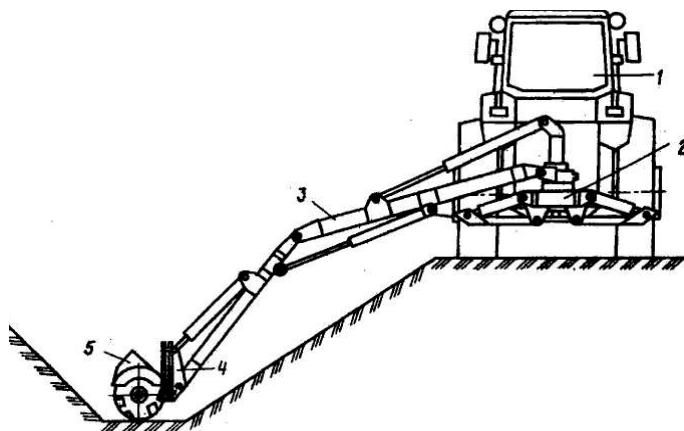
Вариант использования колесного трактора в качестве базы для каналаочистителя: 1 – колесный трактор; 2 – задняя поворотная колонка; 3 – рабочее оборудование; 4 – механизм поворота сменного рабочего органа; 5 – сменный рабочий орган
